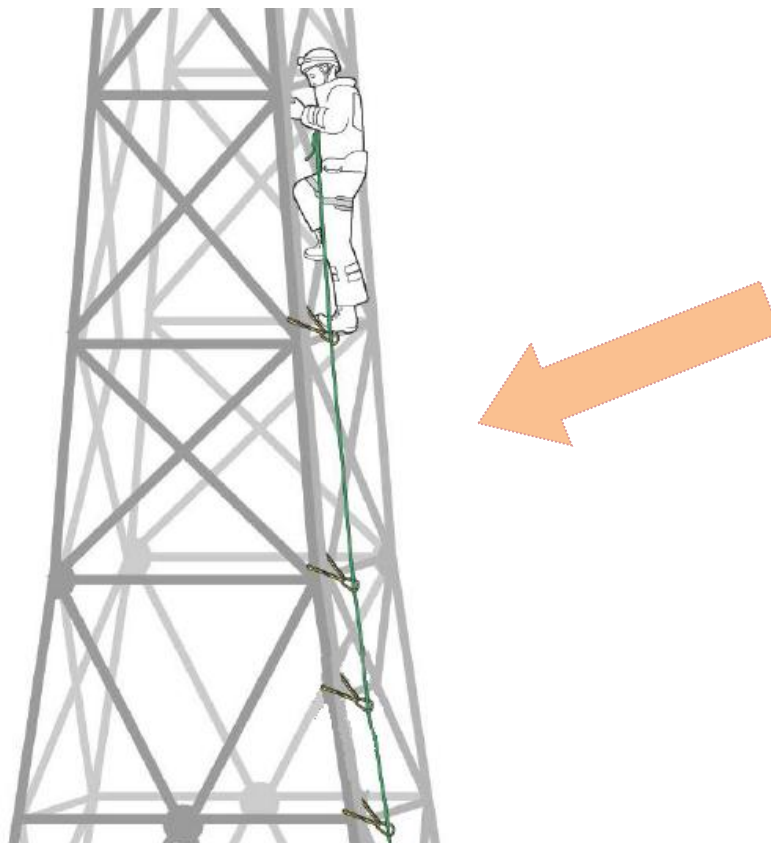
„Spotowanie” przed pierwszym wpięciem
